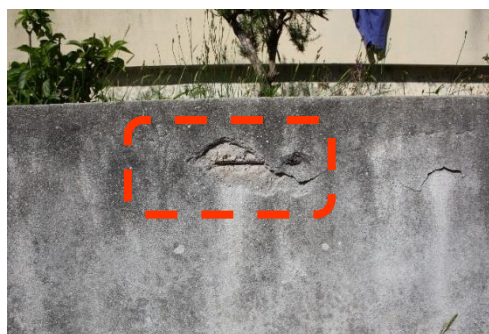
Bloco F, parede de contenção das floreiras exteriores
